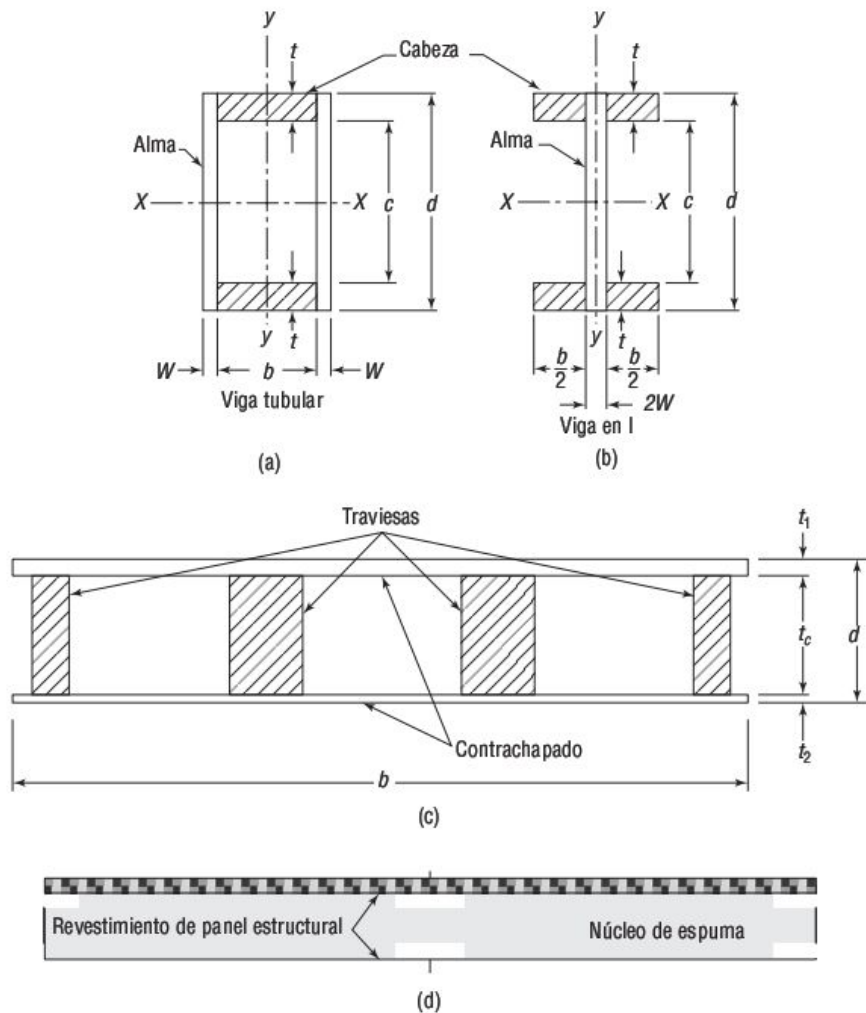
Elementos estructurales compuestos: (a) viga tubular, (b) viga en I, (c) chapas de forro y (d) paneles estructurales aislados.
